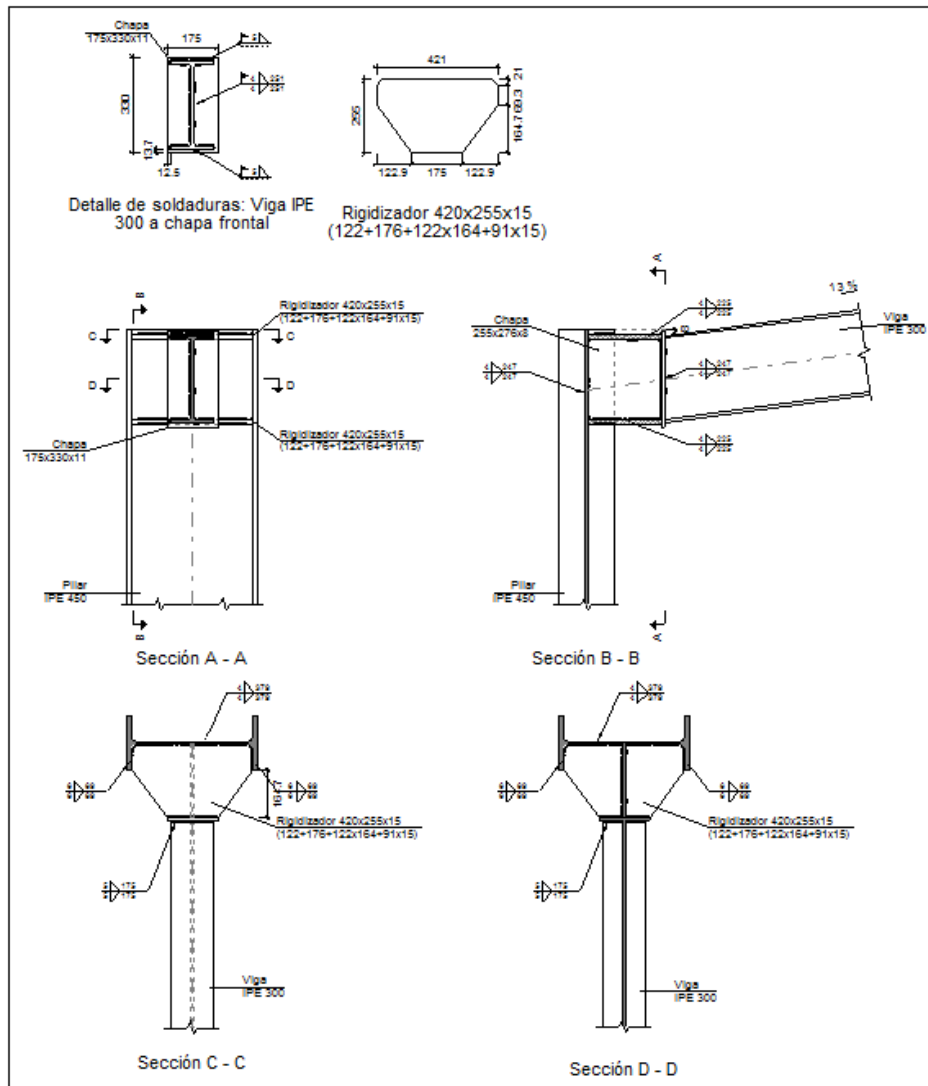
Detalle de unión entre jácena y pilar en pórticos de fachada, tipo 7 (CYPE)
